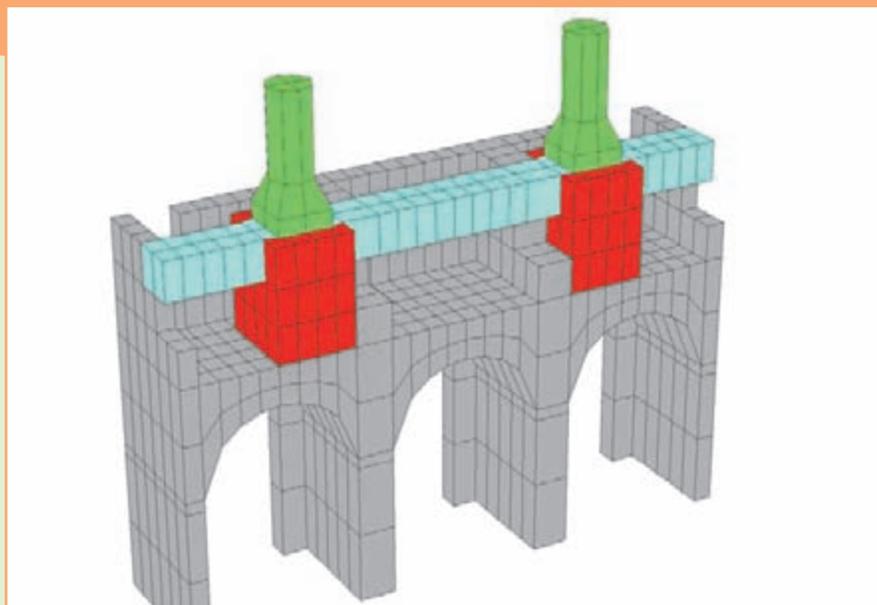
Costruzione della trave di spina per il solaio di pavimento della sala capitolare
